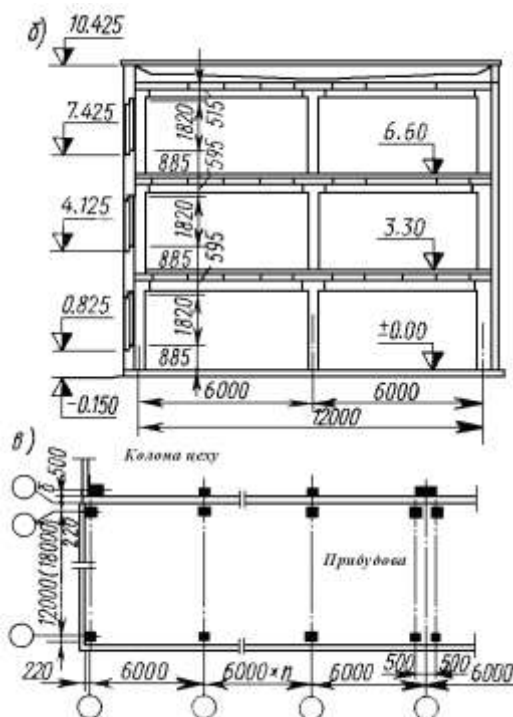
Об'ємне планувальне рішення прибудованих адміністративно-побутових будівель, що окремо стоять: б – поперечний розріз; в – примикання до торцевої стіни цеху
